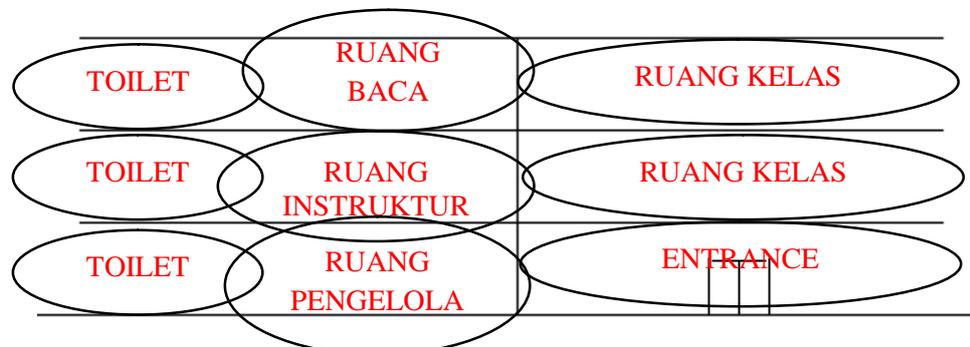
Skematik Selubung Bangunan (Tampak Utara)
